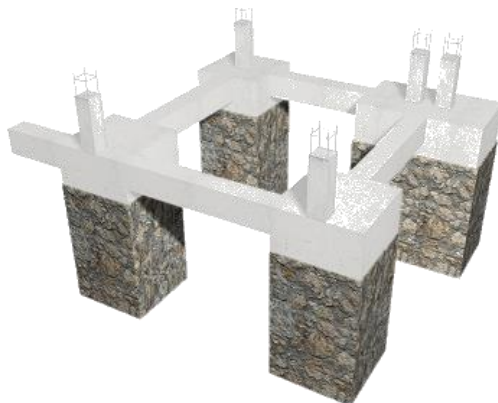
Modelo de cimentación planteado mediante pozos de cimentación.
